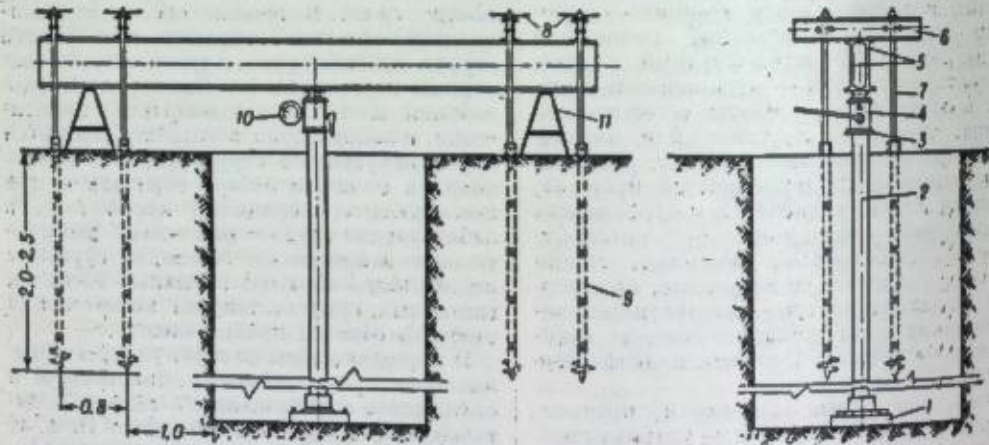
Установка для испытания грунта штампом в шурфе: 1 — штамп; 2 — труба; 3 — прокладка из листового железа; 4 — гидравлич. домкрат; 5 и 6 — упорные балки; 7 — монтажные болты; 8 — стопорные барашки; 9 — винтовые анкерные сваи; 10 — манометр; 11 — монтажный козел.
